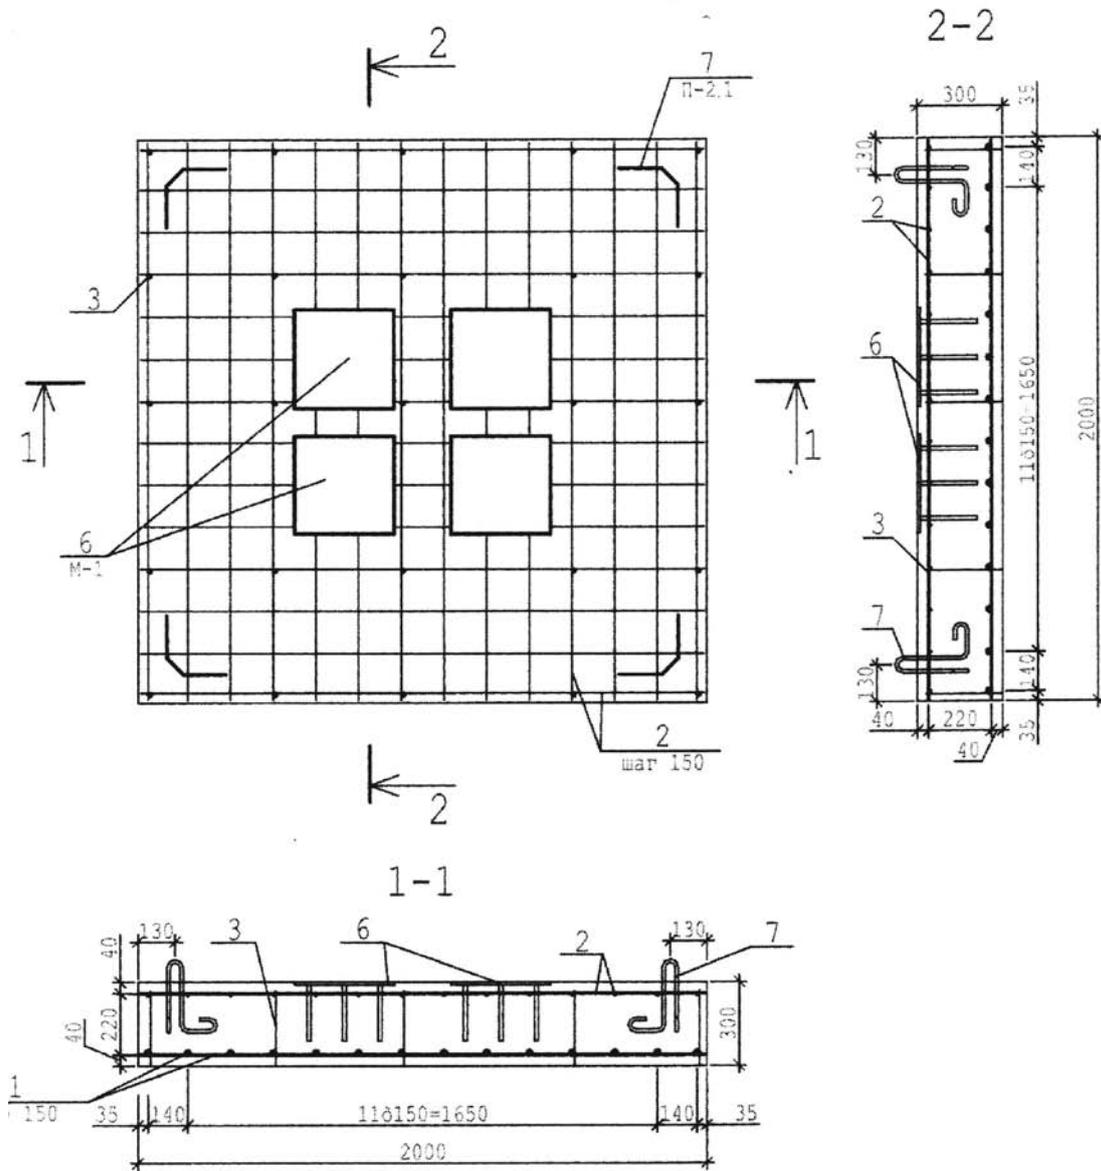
Вариант железобетонной плиты-подпятника 2000 x 2000 x 300 мм (разработчик ООО “АзьПроектСтрой”).
